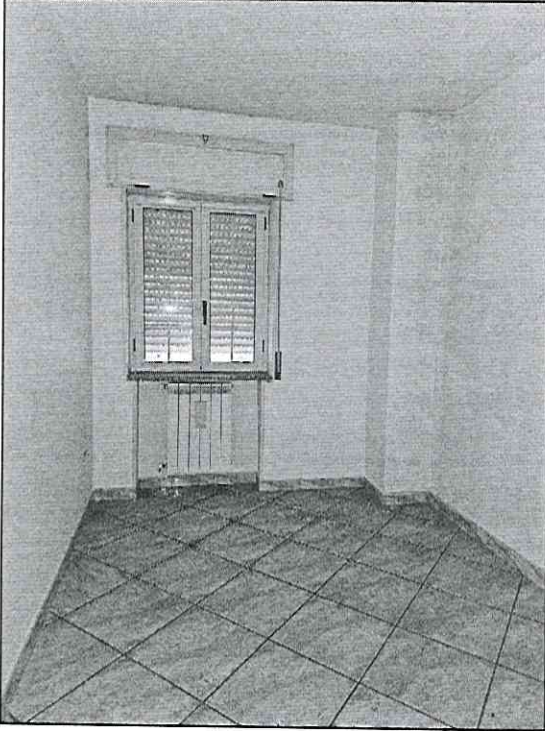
Piano Primo - Interni (Camera da letto S.)
